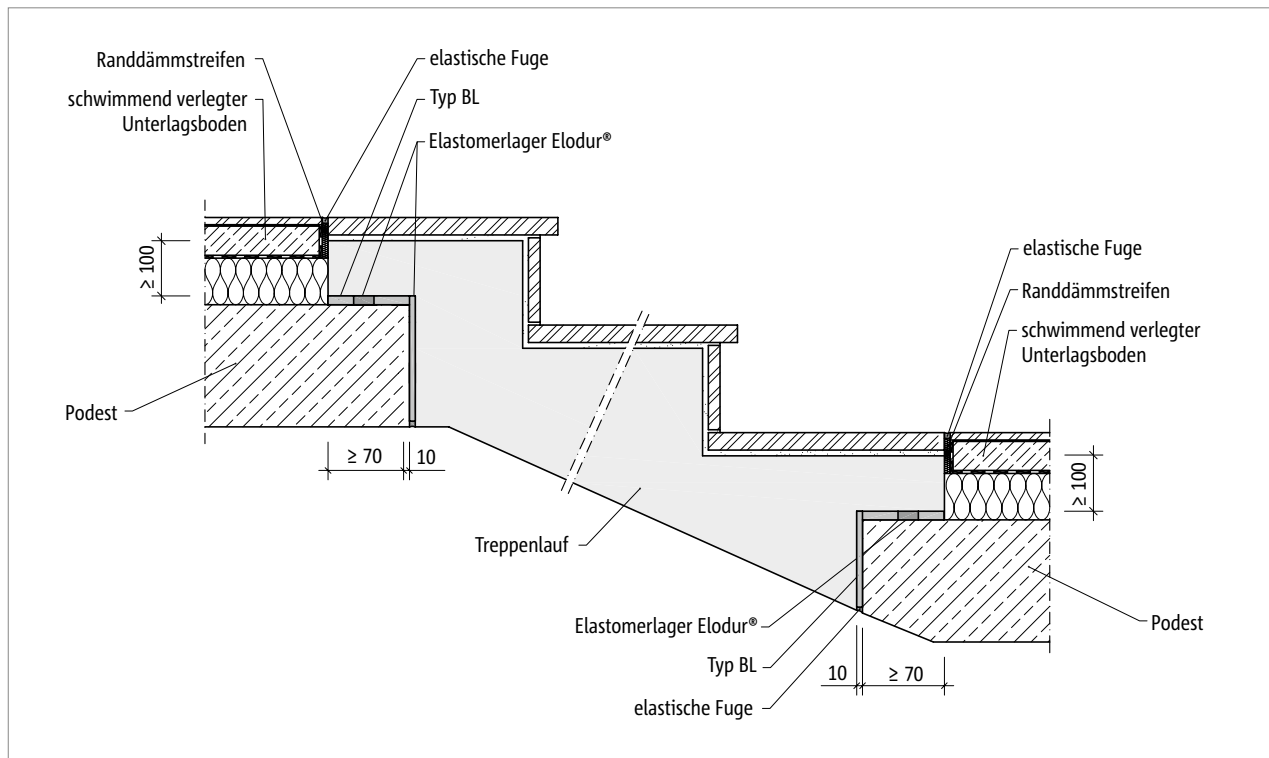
Schöck Tronsole® Typ BL: Einbauschnitt
